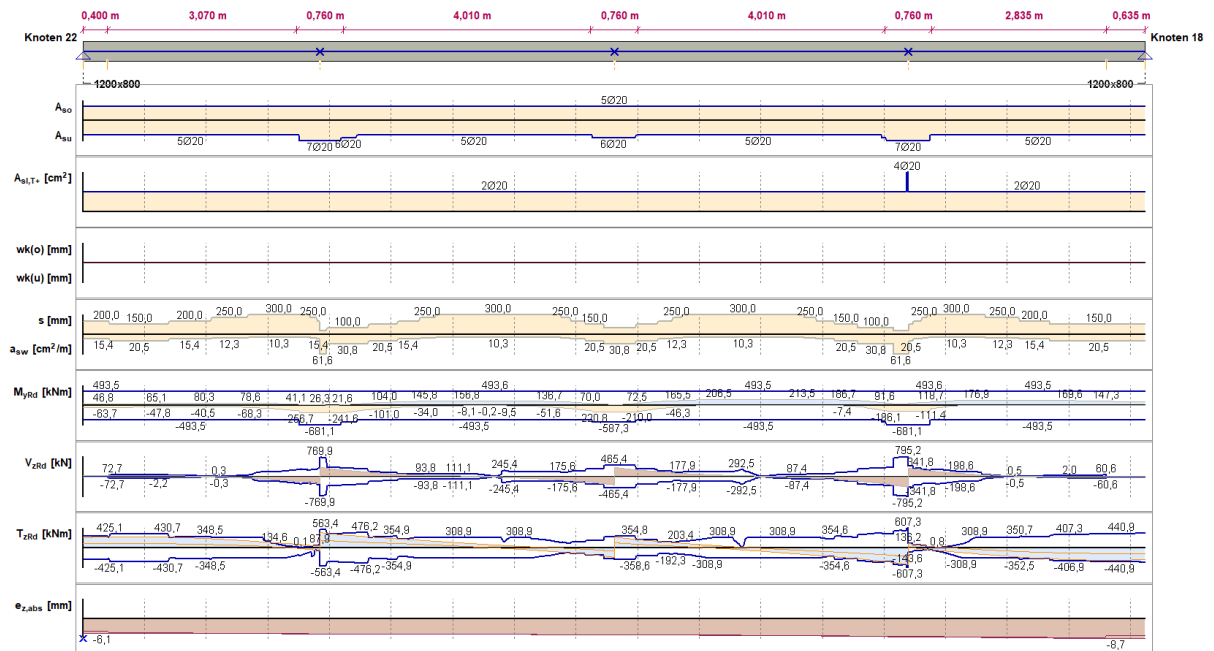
Berechnete Balkenbewehrung, Achse 10, vertikale Ebene
